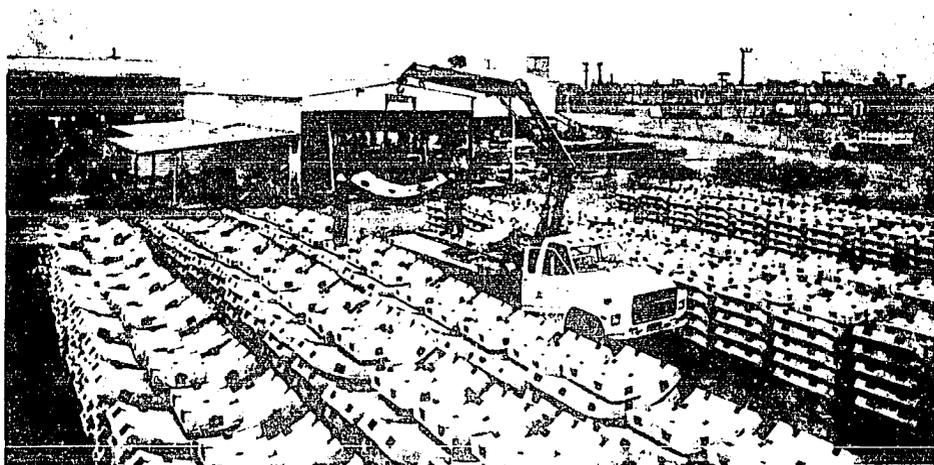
PANORAMA DE LA PLANTA DE DOVELAS, EN PRIMER PLANO SE OBSERVA EL PRODUCTO TERMINADO.
